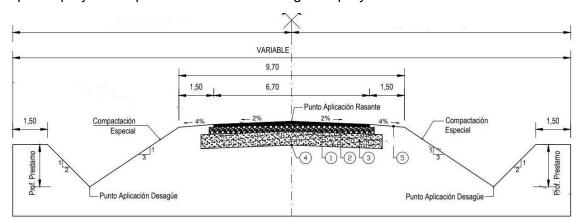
Perfil tipo del paquete estructural y conformación de desagües. Fuente DVBA
